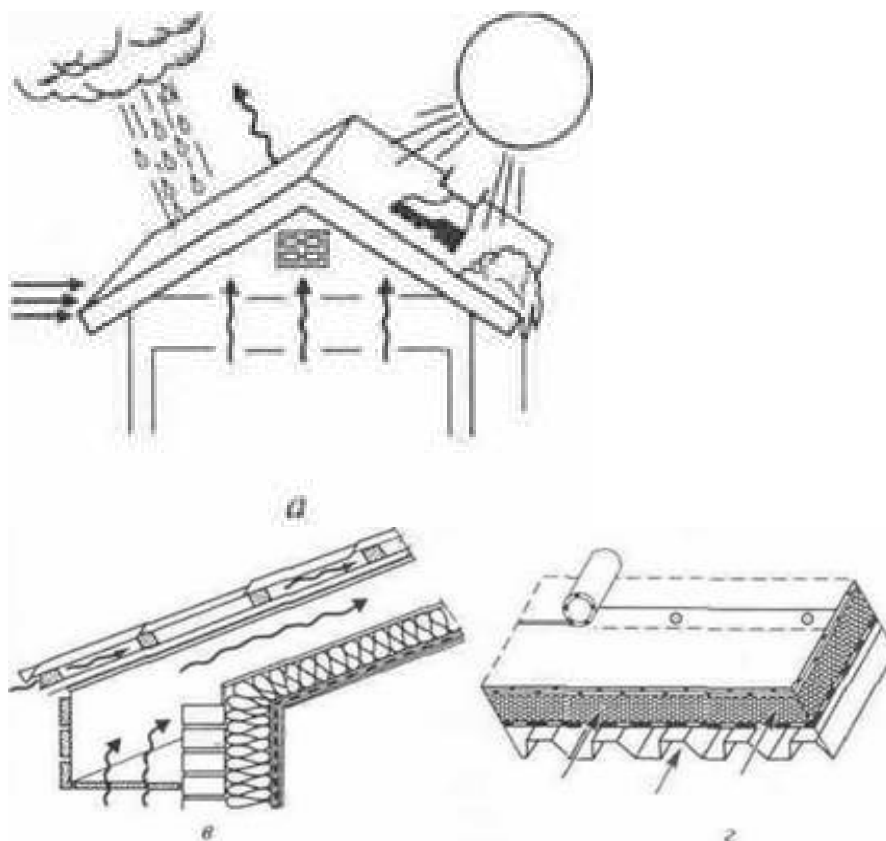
Факторы, воздействующие на кровельное покрытие: а — влажностно-механическое воздействие; б — движение воздуха внутри и снаружи покрытия; в — проветривание мансардного этажа; г — «дышащее» кровельное покрытие
